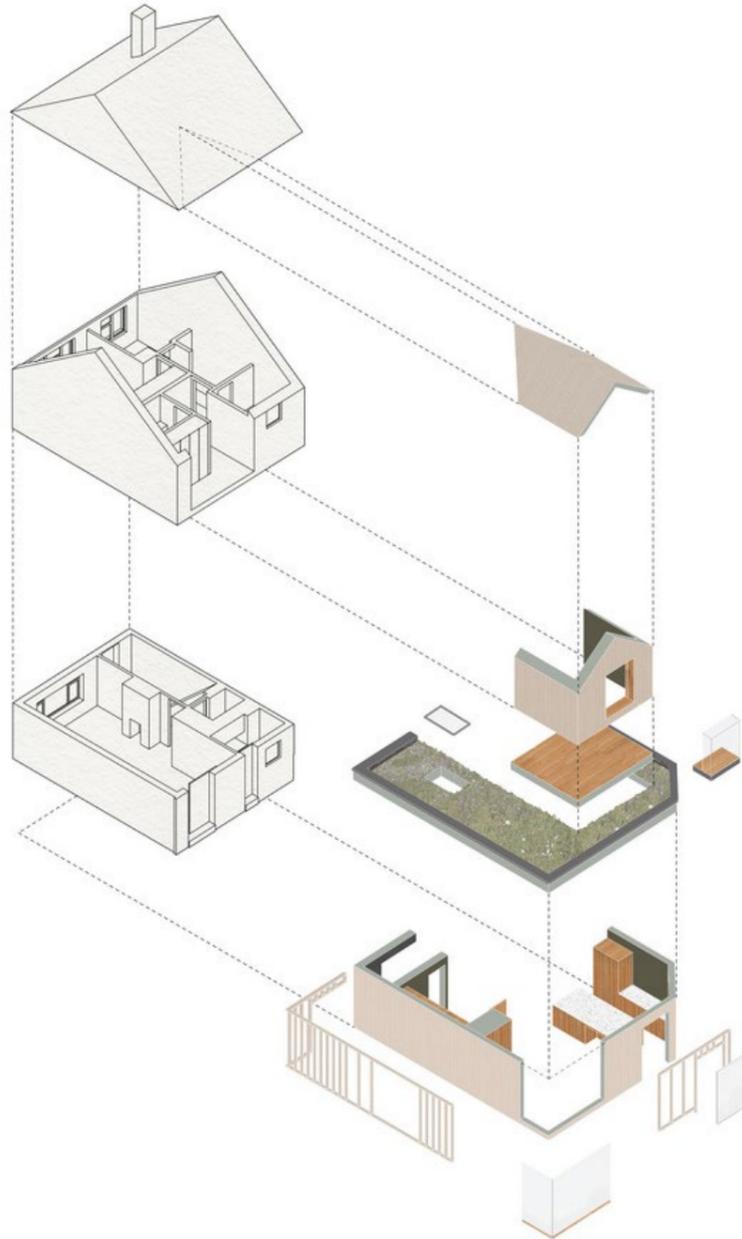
Corner View House. Visualizzazione assonometrica. Fonte: <https://www.archdaily.com/991609/corner-view-house-freehaus>
